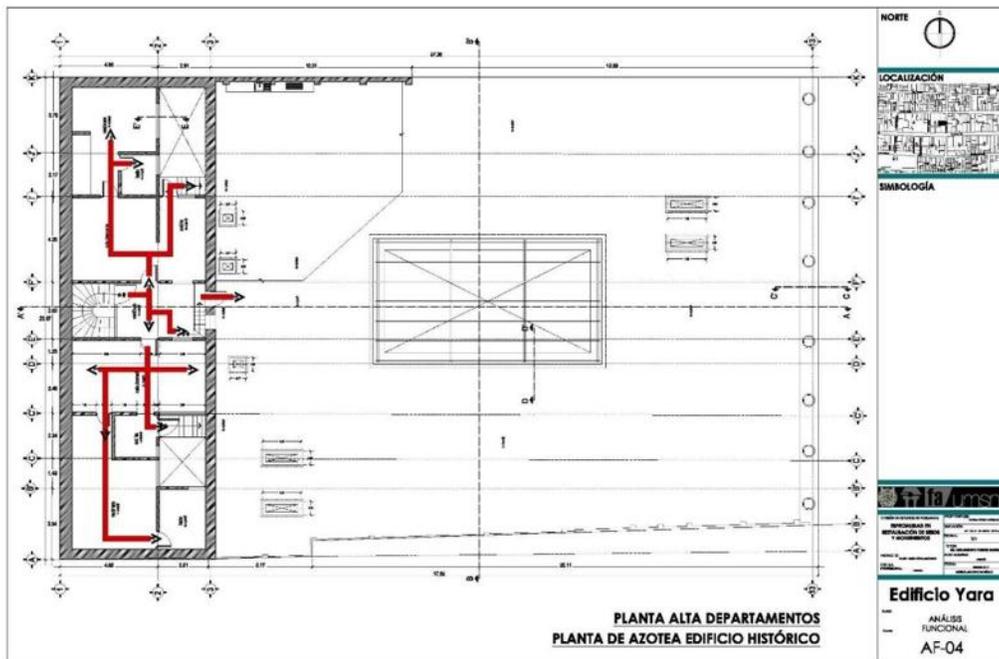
Plano de circulaciones en planta alta de departamentos.
